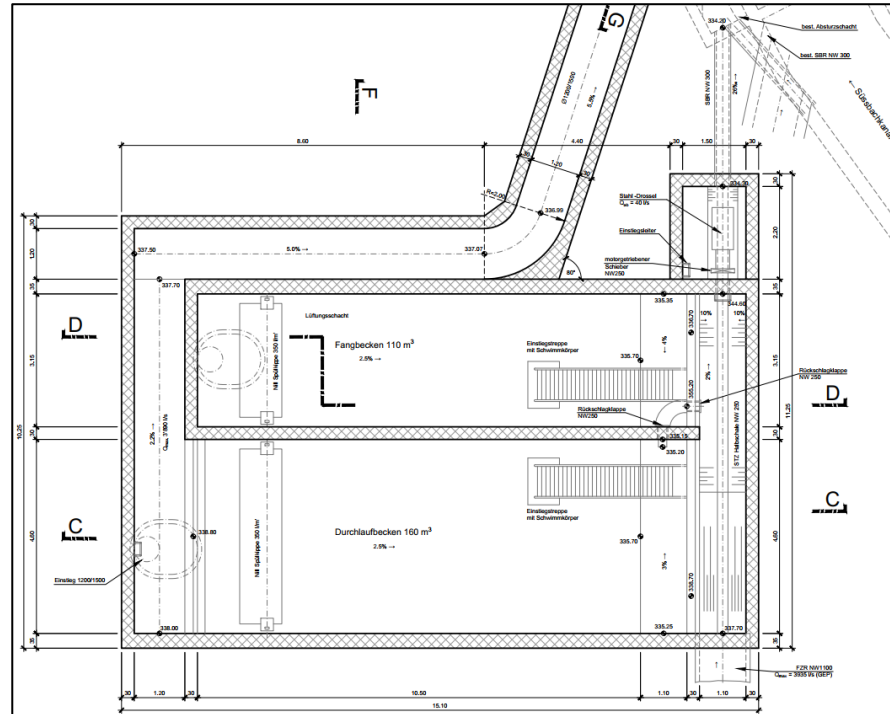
Grundriss RÜB Schöneegg
